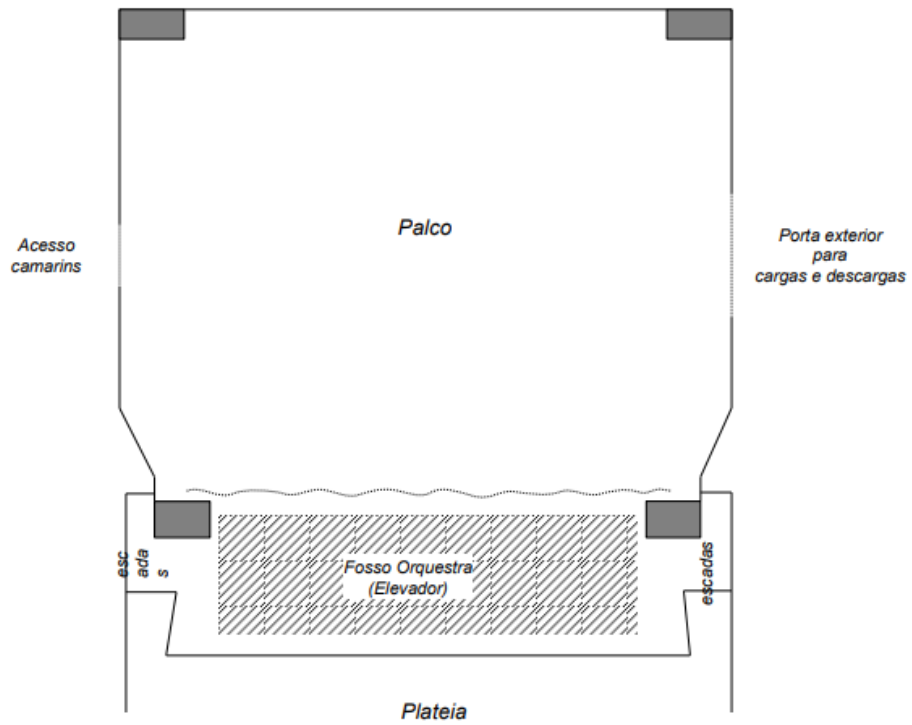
Planta de palco do Cineteatro Eduardo Brazão [45]
